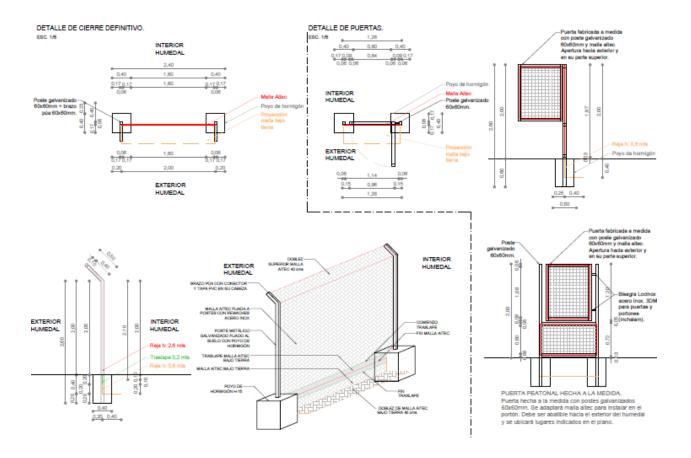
Diseño del Cerco de Exclusión Ecológica.
